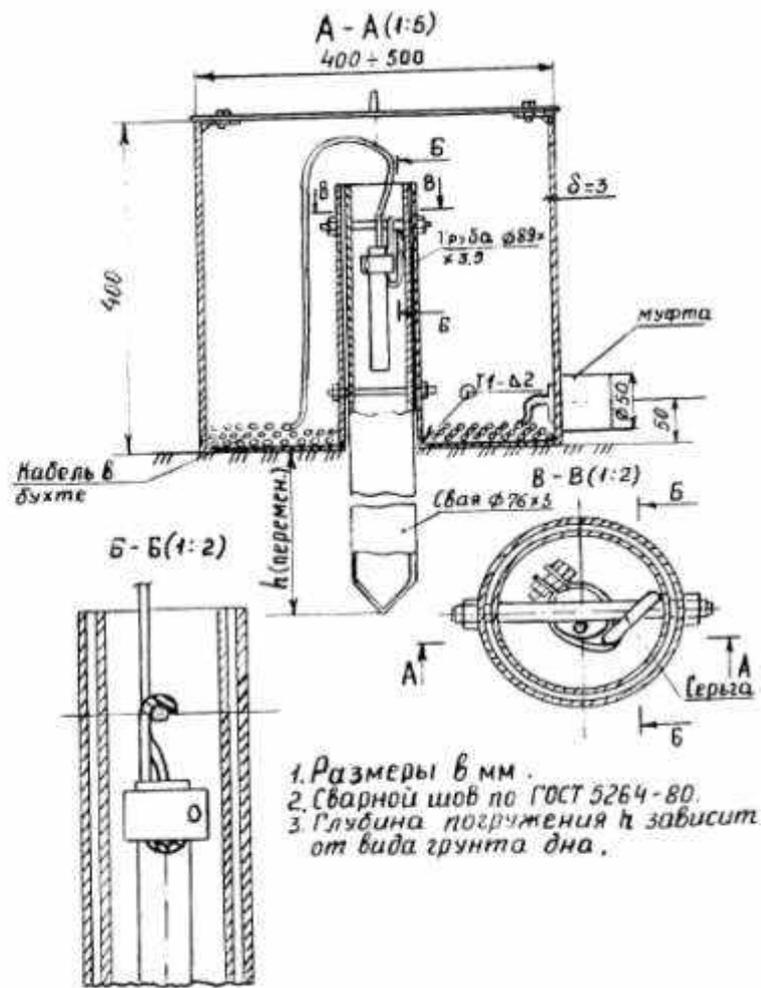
Чертеж конструкции для размещения гидростатического датчика
